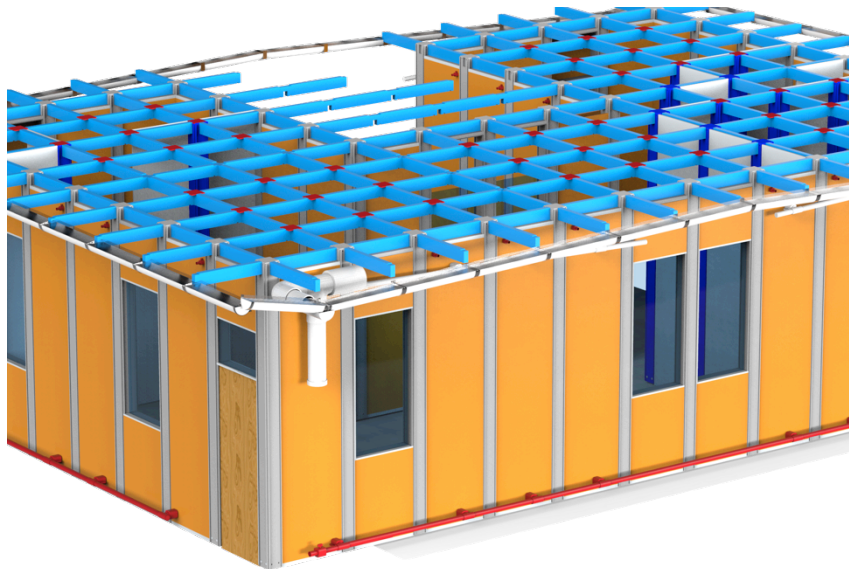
Casa muestra sin Losa de techo. Se muestran vigas y Tapas colocadas en cada intersección entre vigas "X" y "Y".
